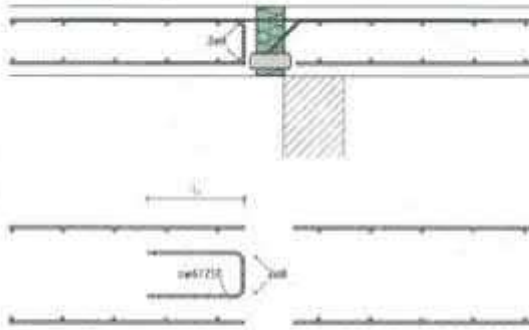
Bewehrungsführung MQ bei direkter Lagerung
